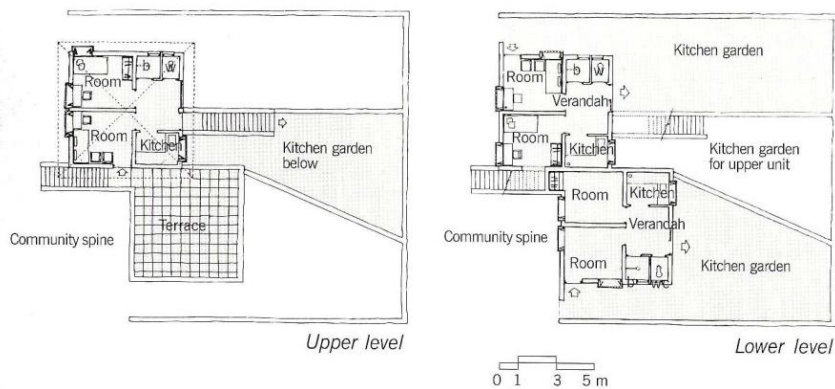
Planos de 1º planta (izquierda) y planta baja (derecha)
